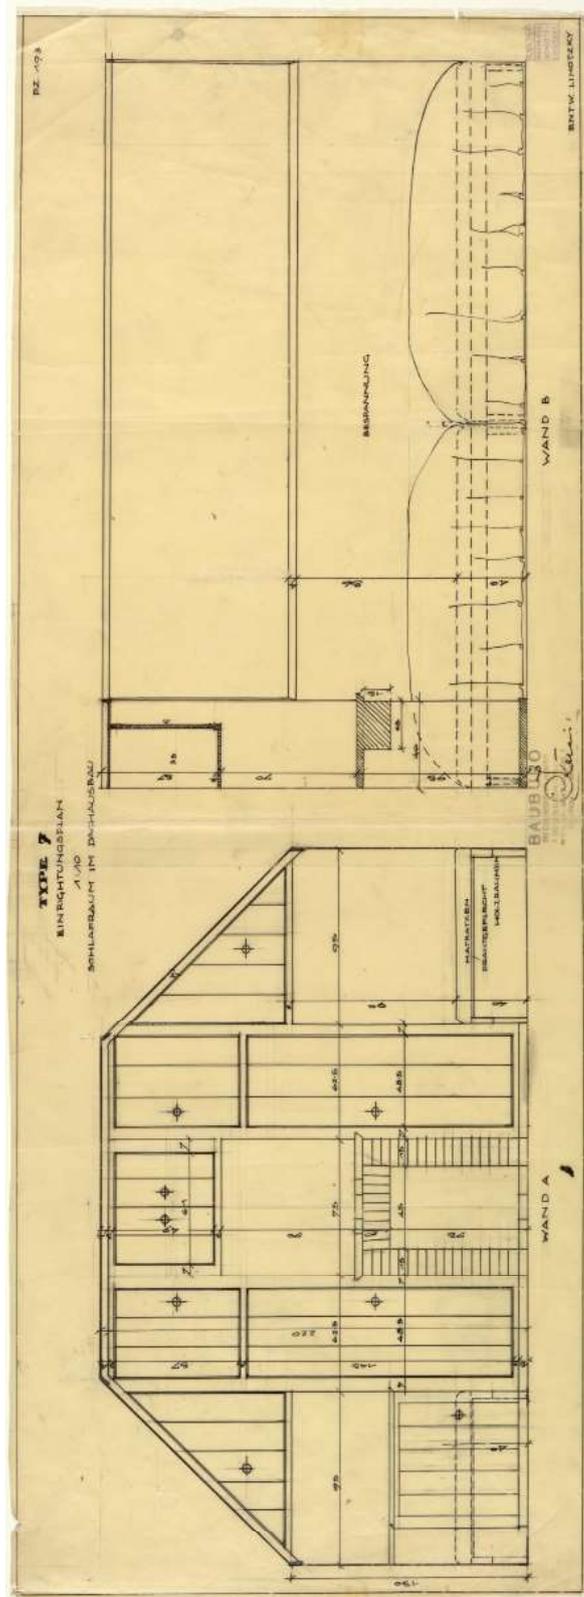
Abb.XVII:Kernhaus Type 7, Einrichtung Schlafzimmer im ausgebauten Dachraum. Wand A.
